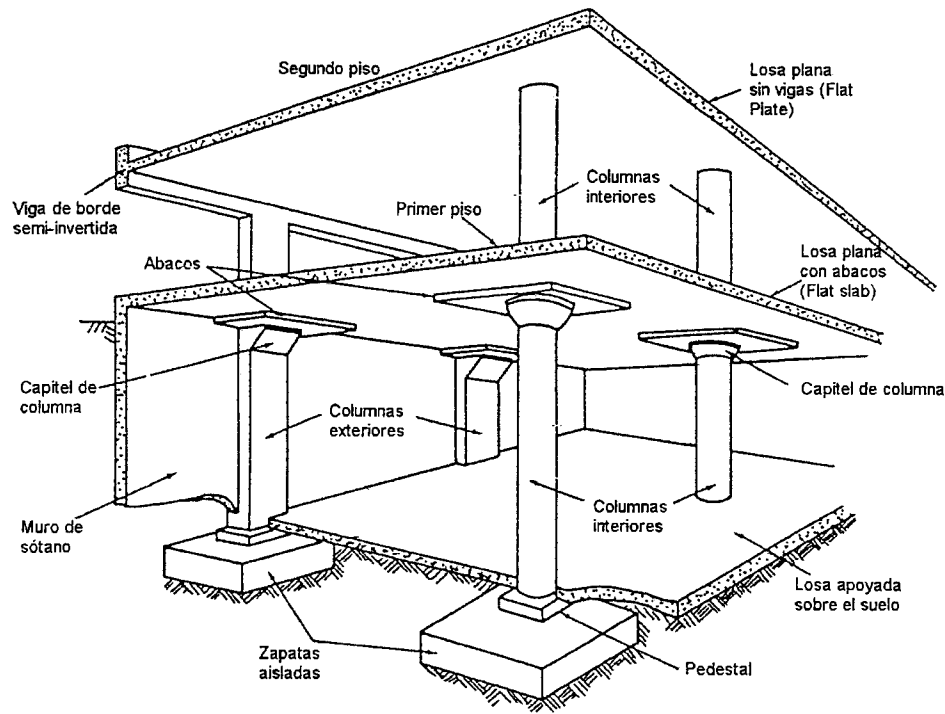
Esquema de un edificio con losas planas (Flat Slab y Flat Plate)
